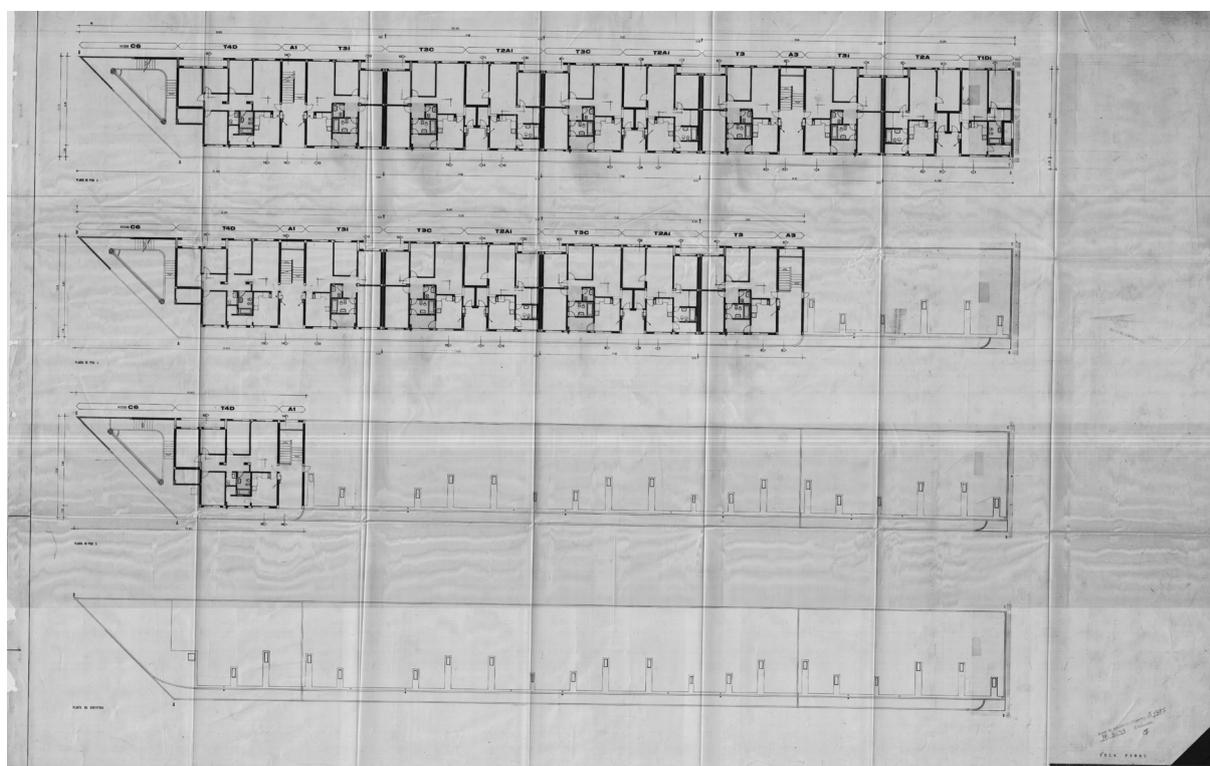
1ª fase do projeto de execução: telas finais, unidade 6, plantas [pisos 3, 4, e cobertura]
